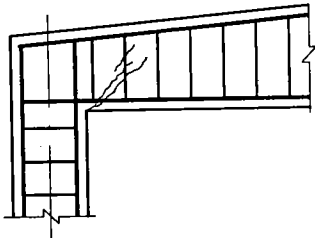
Cốt thép chịu mômen âm không đủ chiều dài
